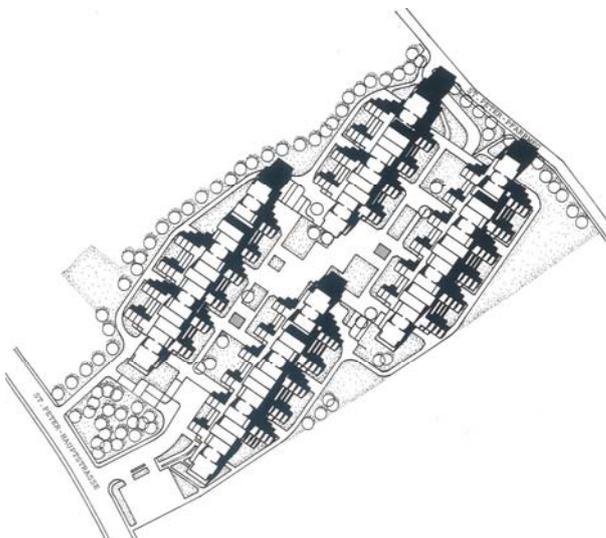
Baukörpersituierung Terrassenhaussiedlung
